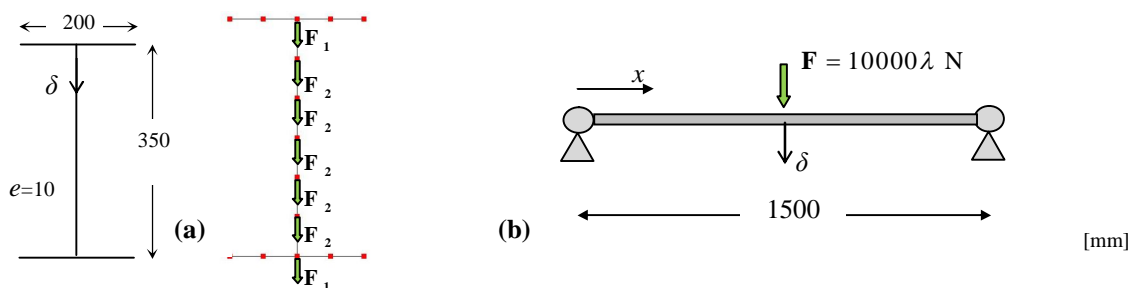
(a) Geometria da secção e localização das cargas pontuais, e (b) modelo estrutural da barra.
